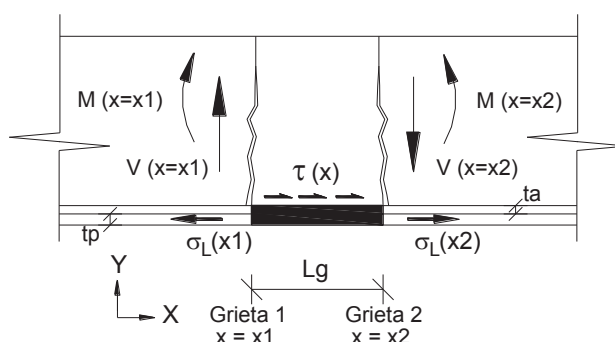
Fuerzas actuantes en un tramo de viga entre dos grietas
